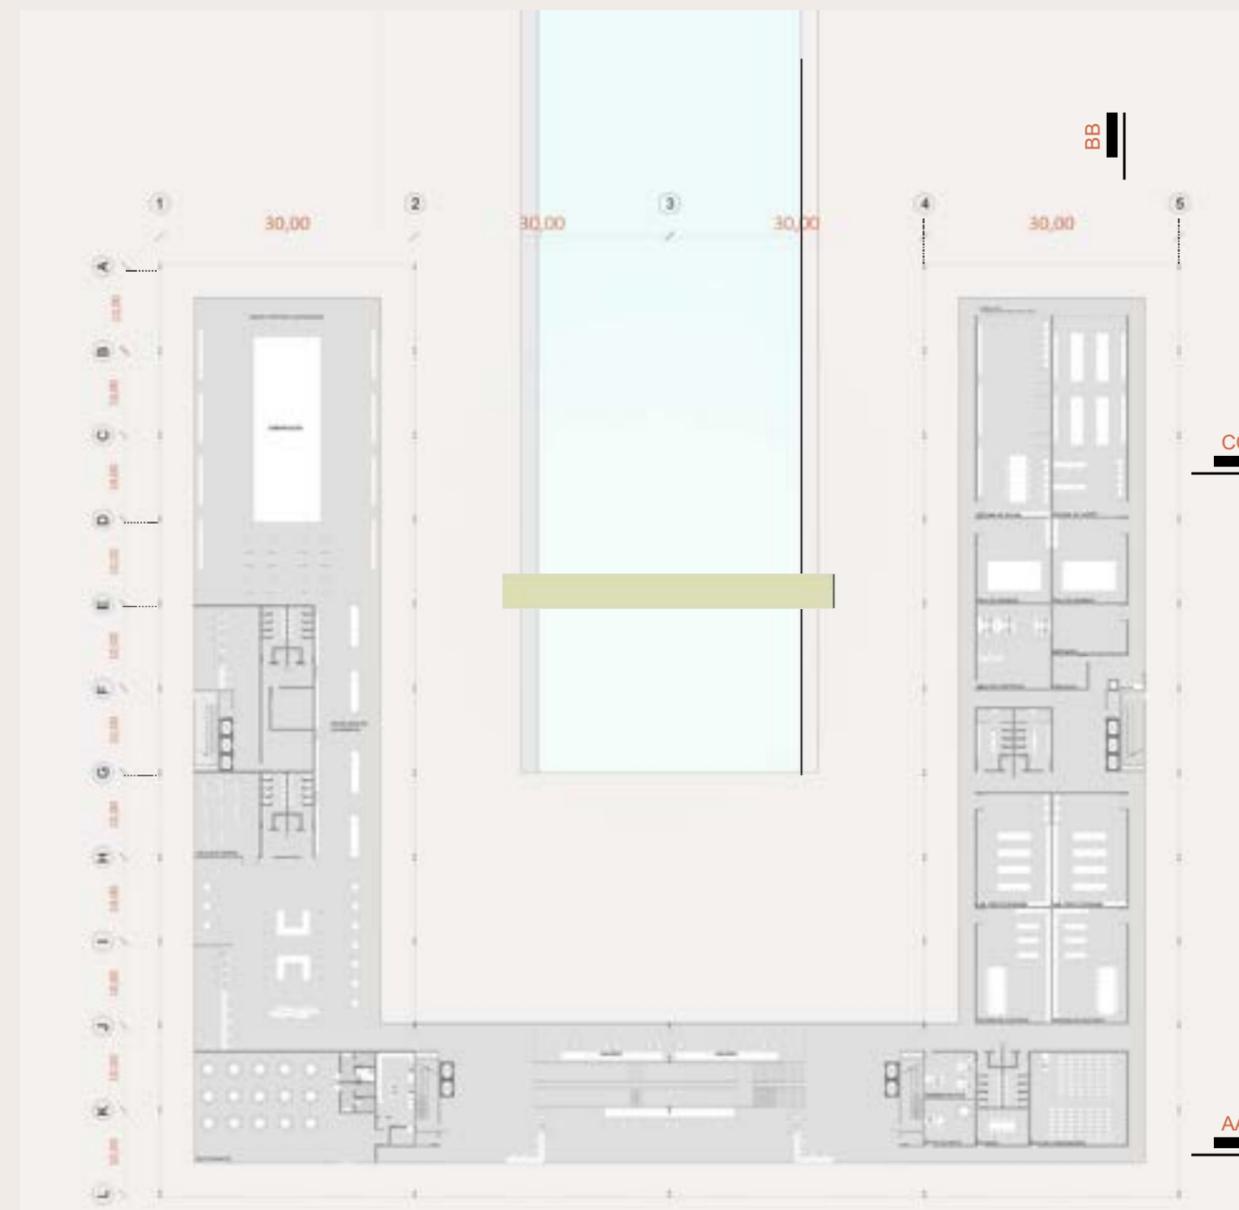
Planta técnica, térreo. Fonte: autoria própria.
